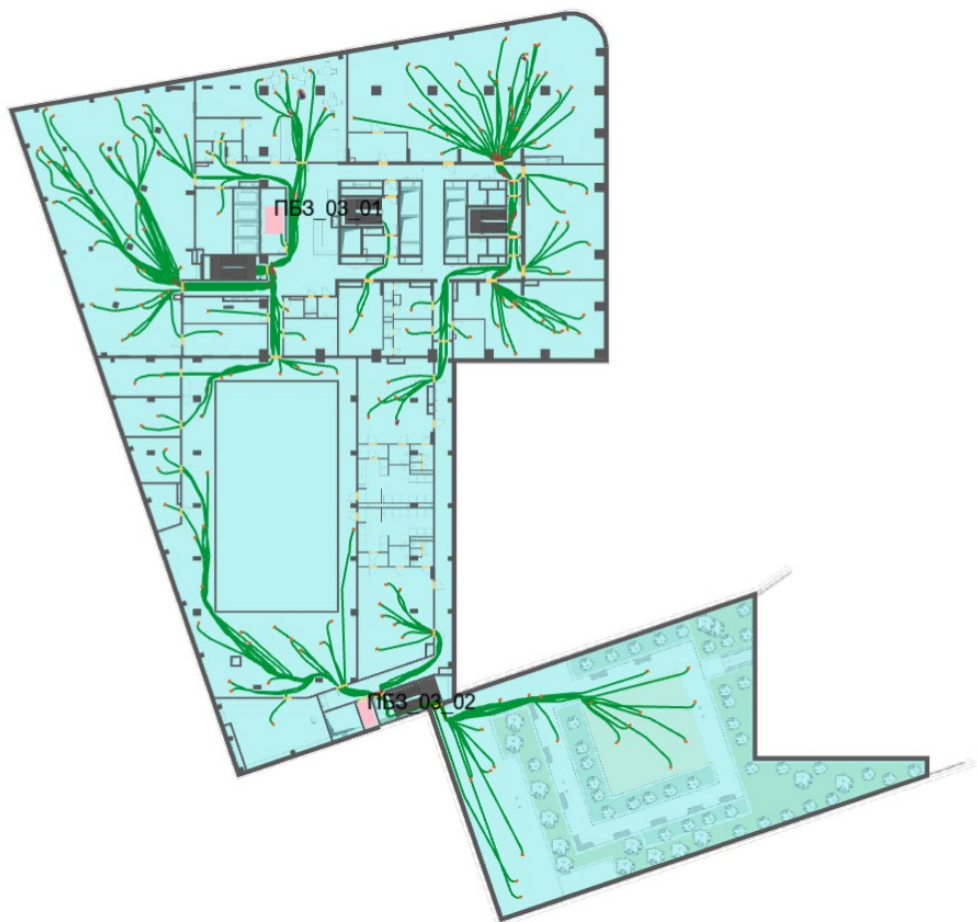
План 3-го этажа и нанесенная на него расчетная (принципиальная) схема эвакуации
